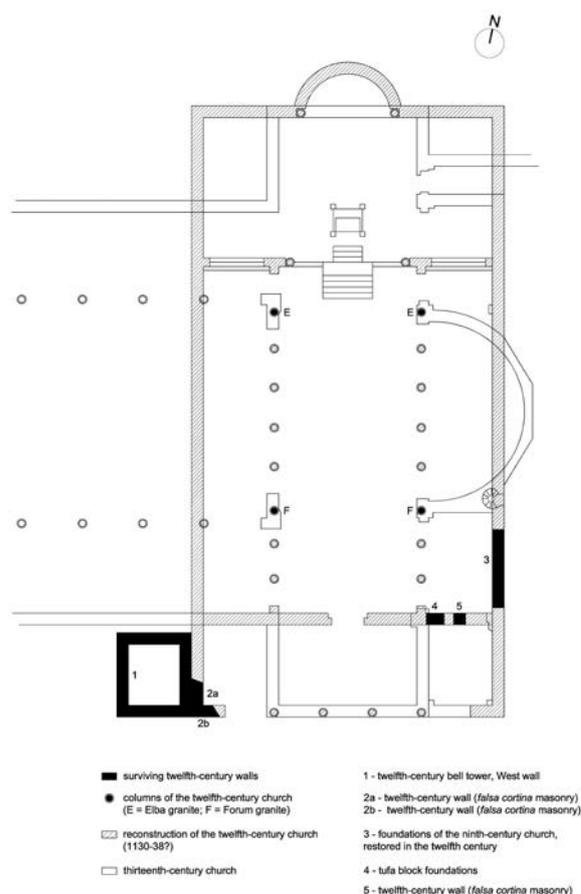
Rom, S. Maria in Aracoeli, hypothetische Grundrissrekonstruktion des Vorgängerbaus mit eingetragenen Fundamentabschnitten des karolingischen Vorgängers und Ergänzungen des 12. Jhs. (nach Bolgia, Reclaiming 2017)
